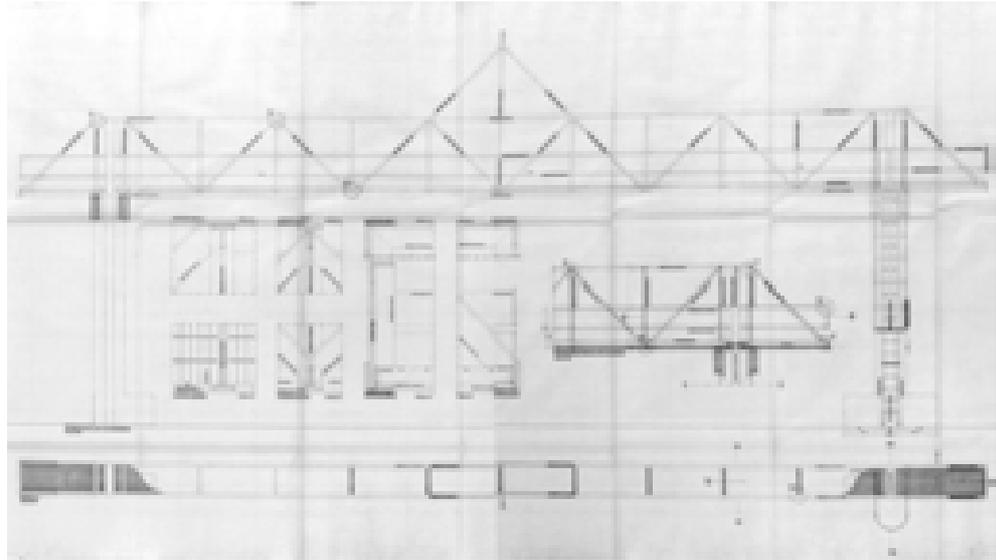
Pilastri con trave di servizio – opere di completamento – 03/05/1998 (AABS-873)
